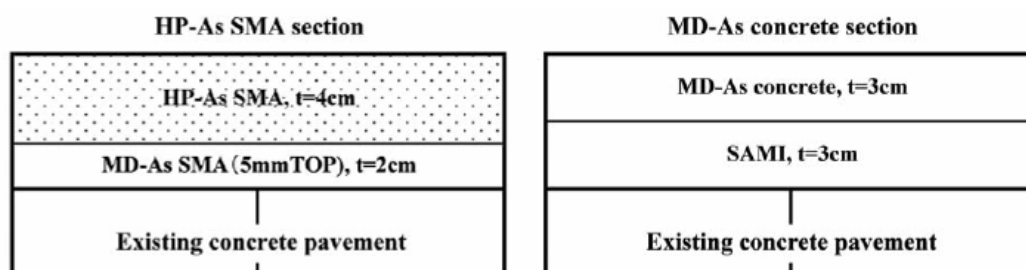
Estruturas de pavimentos estudadas por SHIMAZATI et al. (2010)
